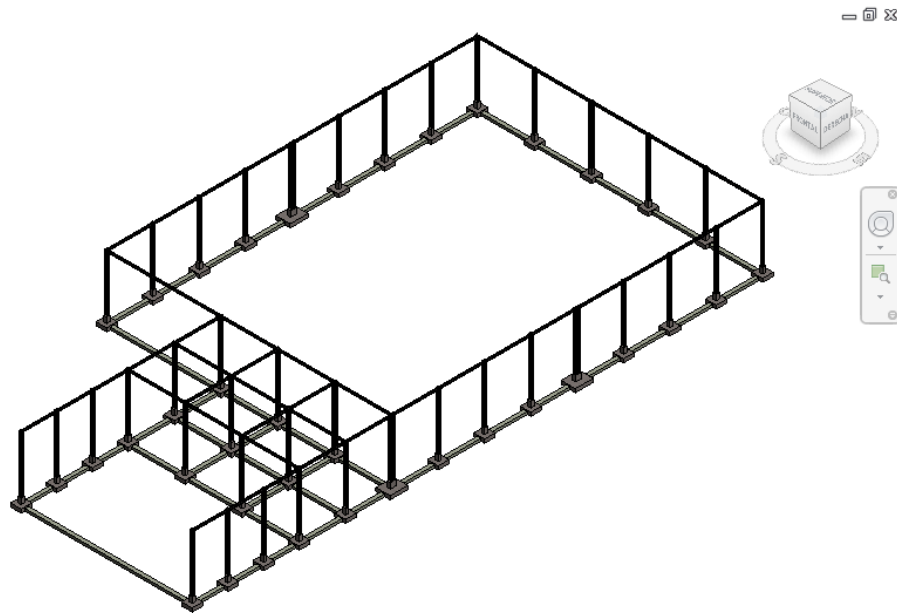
Propuesta de colocación de vigas IPN 300 de atado para los pilares.
